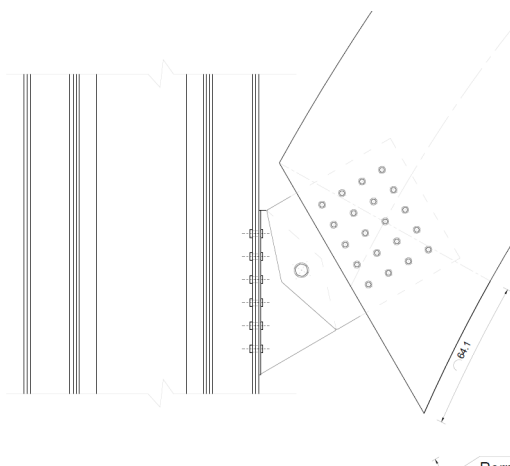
Detalle de la unión entre el arco (e_1) y el pilar (e_2)
